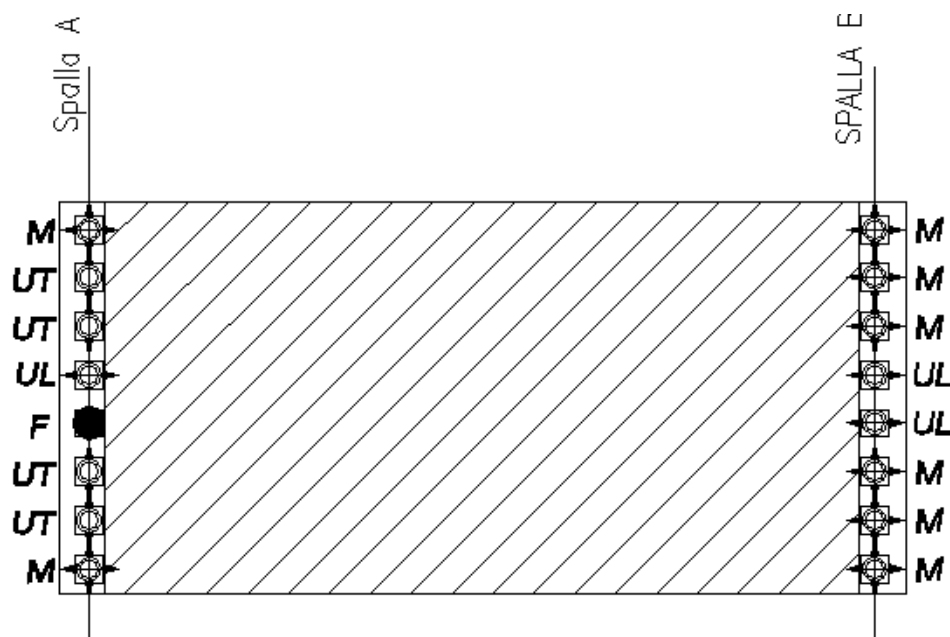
Schema disposizione appoggi – Rampa Laterale
